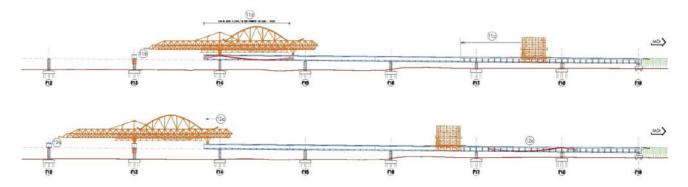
Detalle de las distintas fases del proceso constructivo: construcción del cajón central mediante autocimbra y pretensado del mismo en primera fase, y tres vanos por detrás construcción de los voladizos y pretensado del tablero completo en segunda fase.
